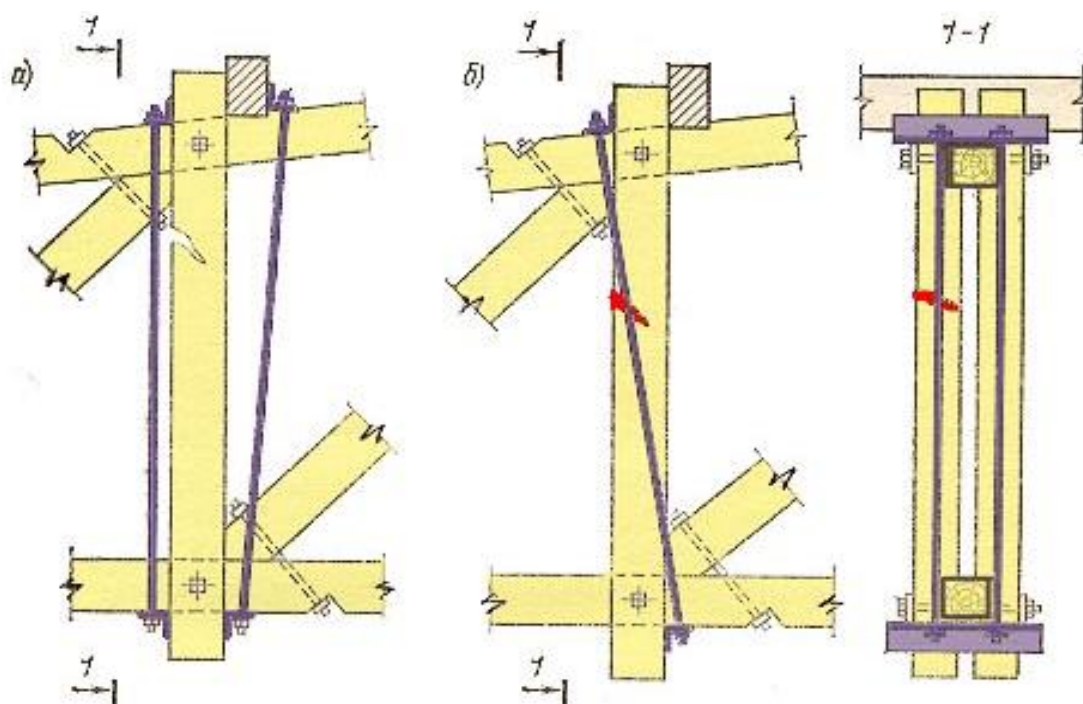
Усиление растянутой стойки фермы стальными тяжами
